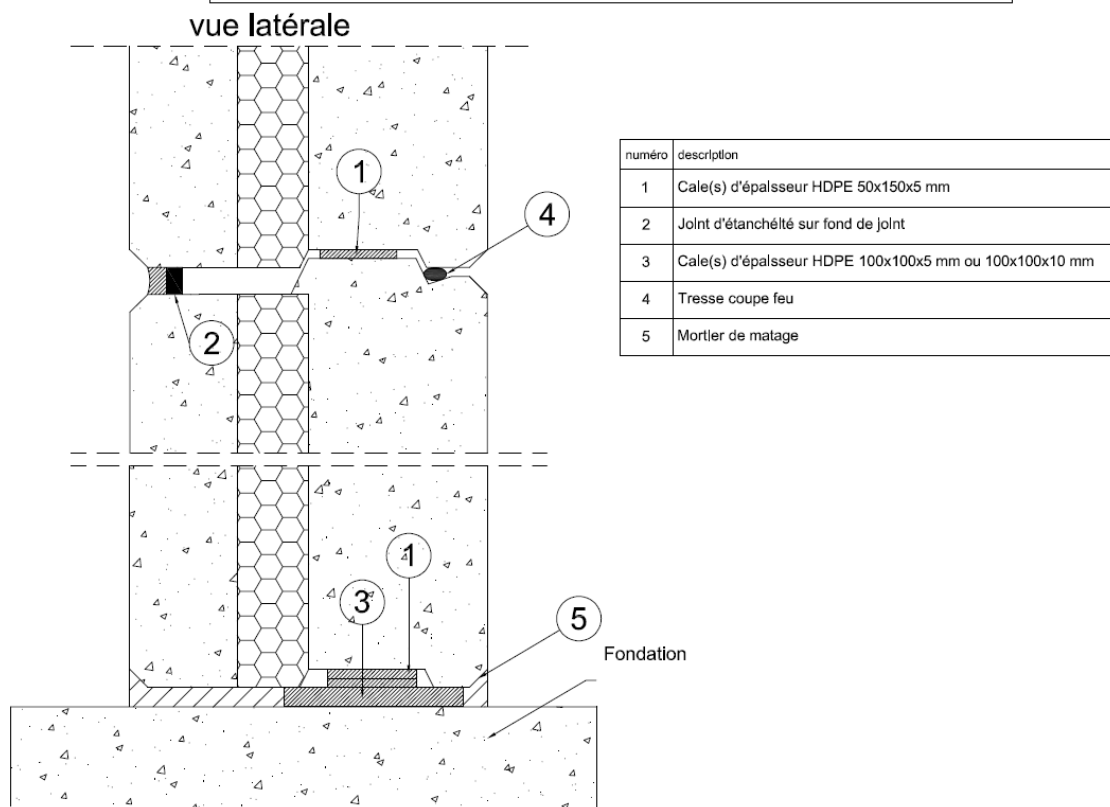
Pose des panneaux dans le cas d'un mur CF (exemple)
